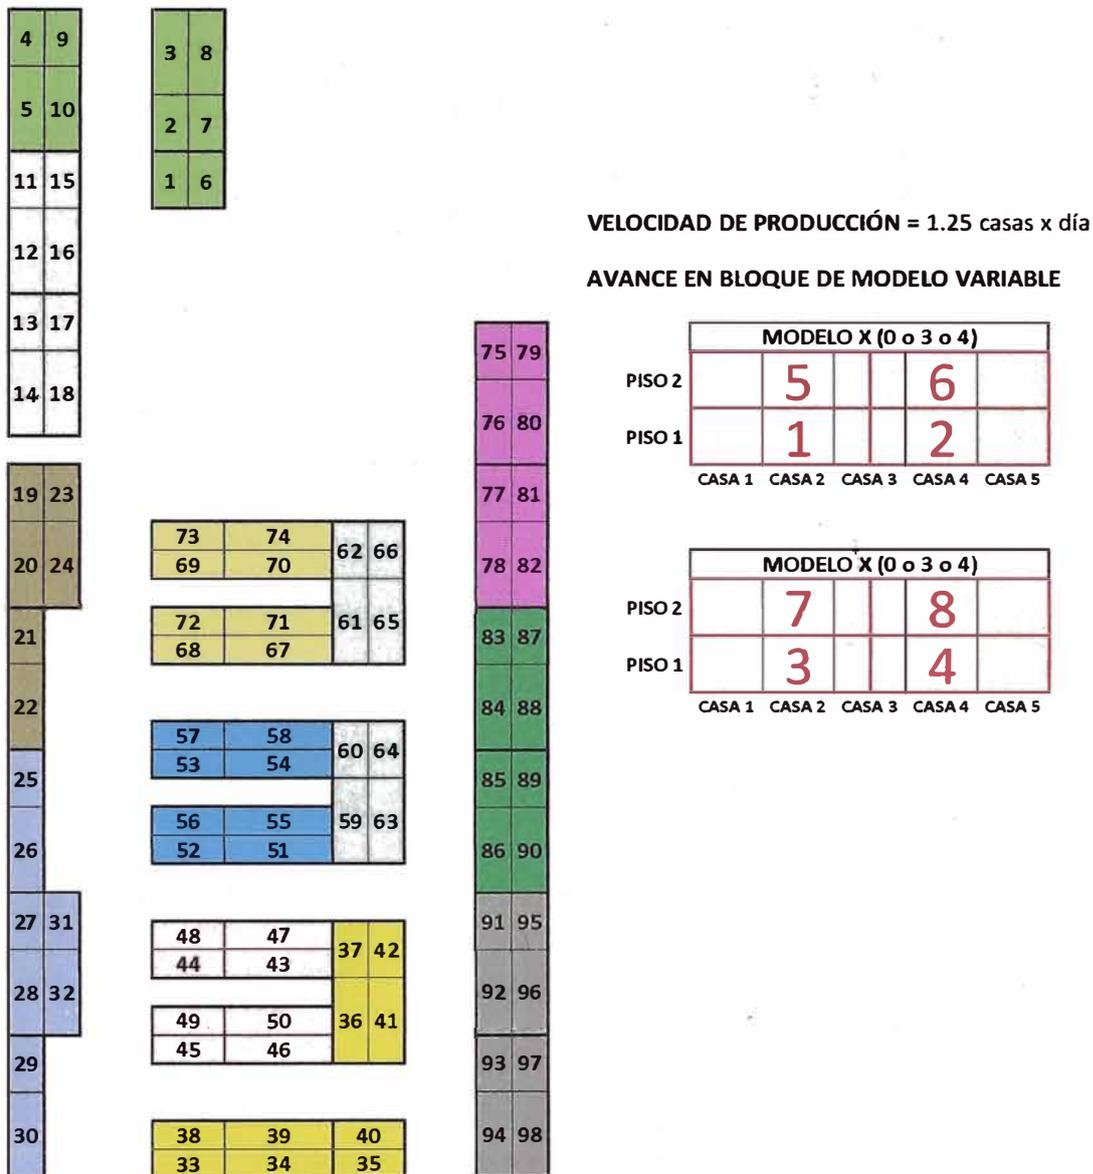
Sectorización de Superestructuras (Propuesta 3)
